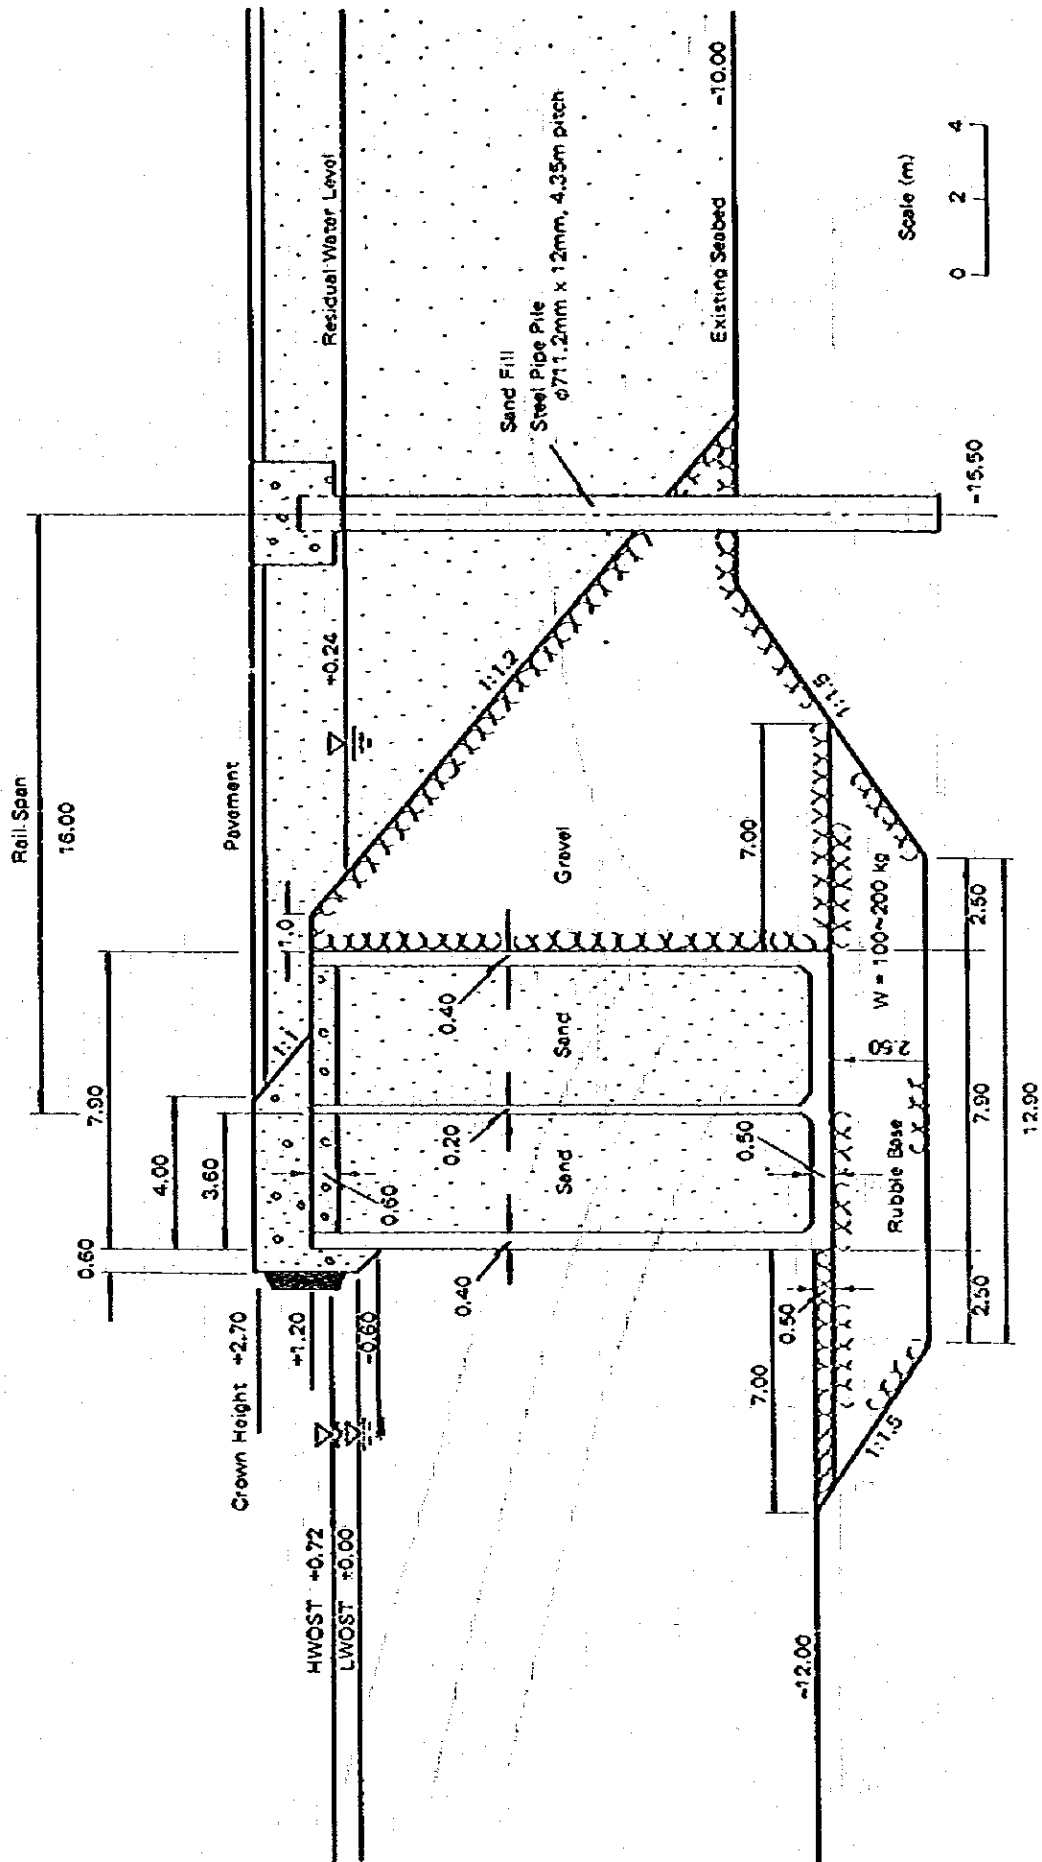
(b) 電力式ゲートン構造平面図 (- 12 m)
